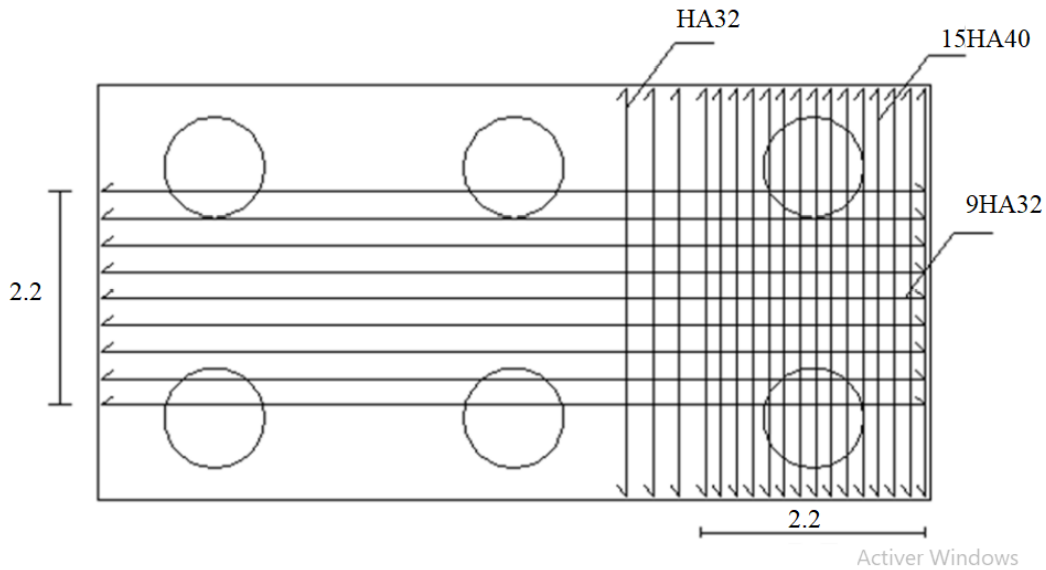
Ferrailage de la semelle en plan (nappe supérieure)
